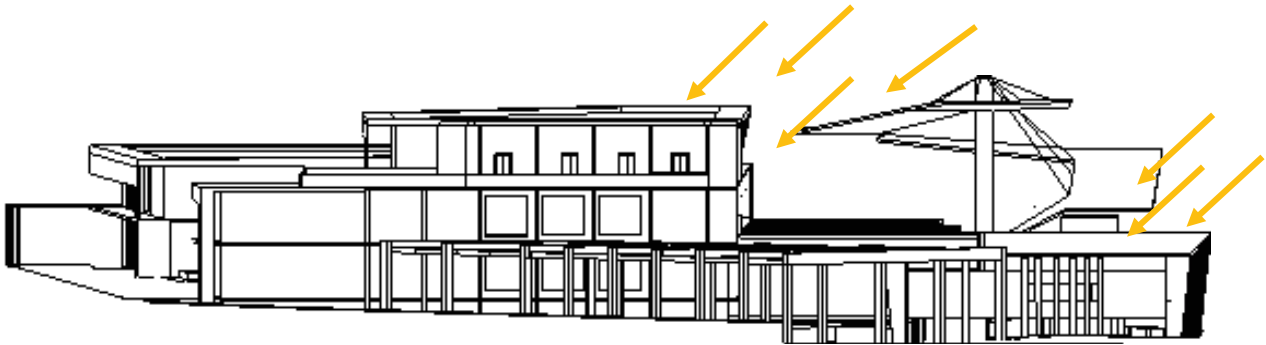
le fonctionnement brise soleil vertical en Eté sur la façade ouest
